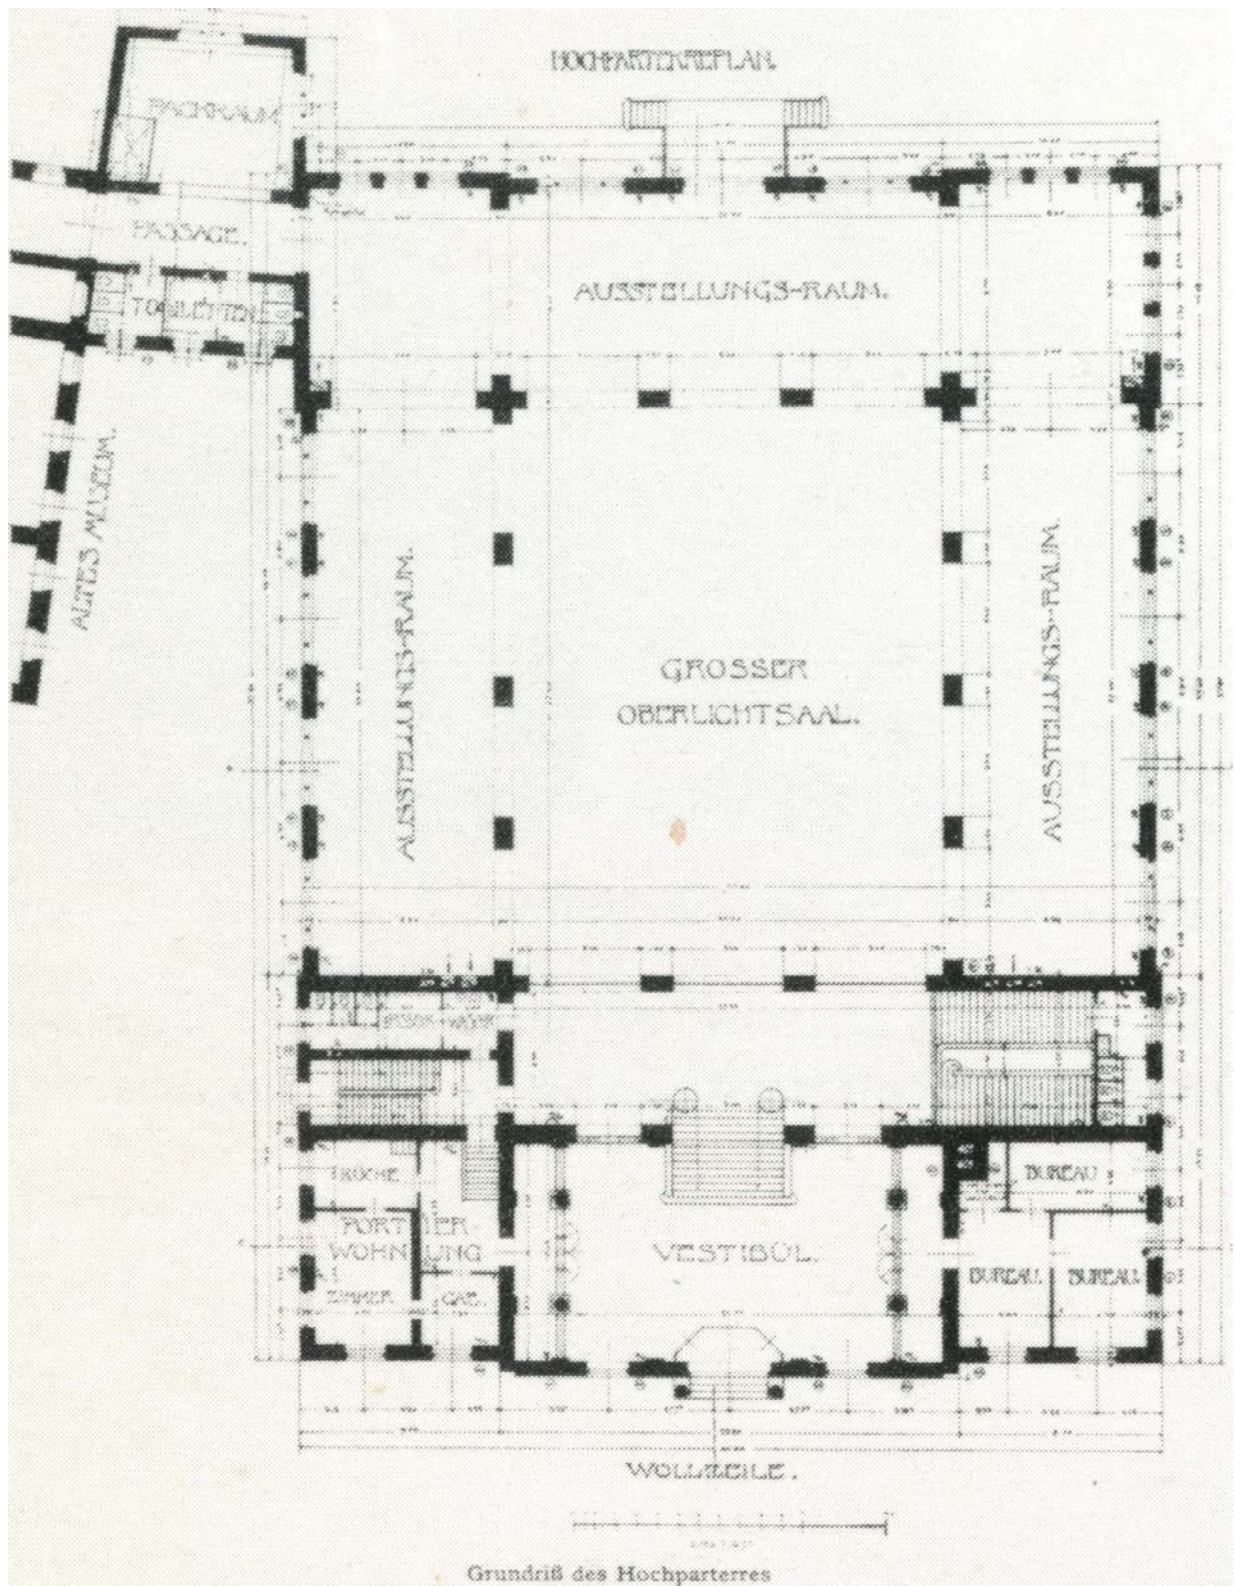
Ludwig Baumann, Erweiterungsbau, Grundriss, 1906
